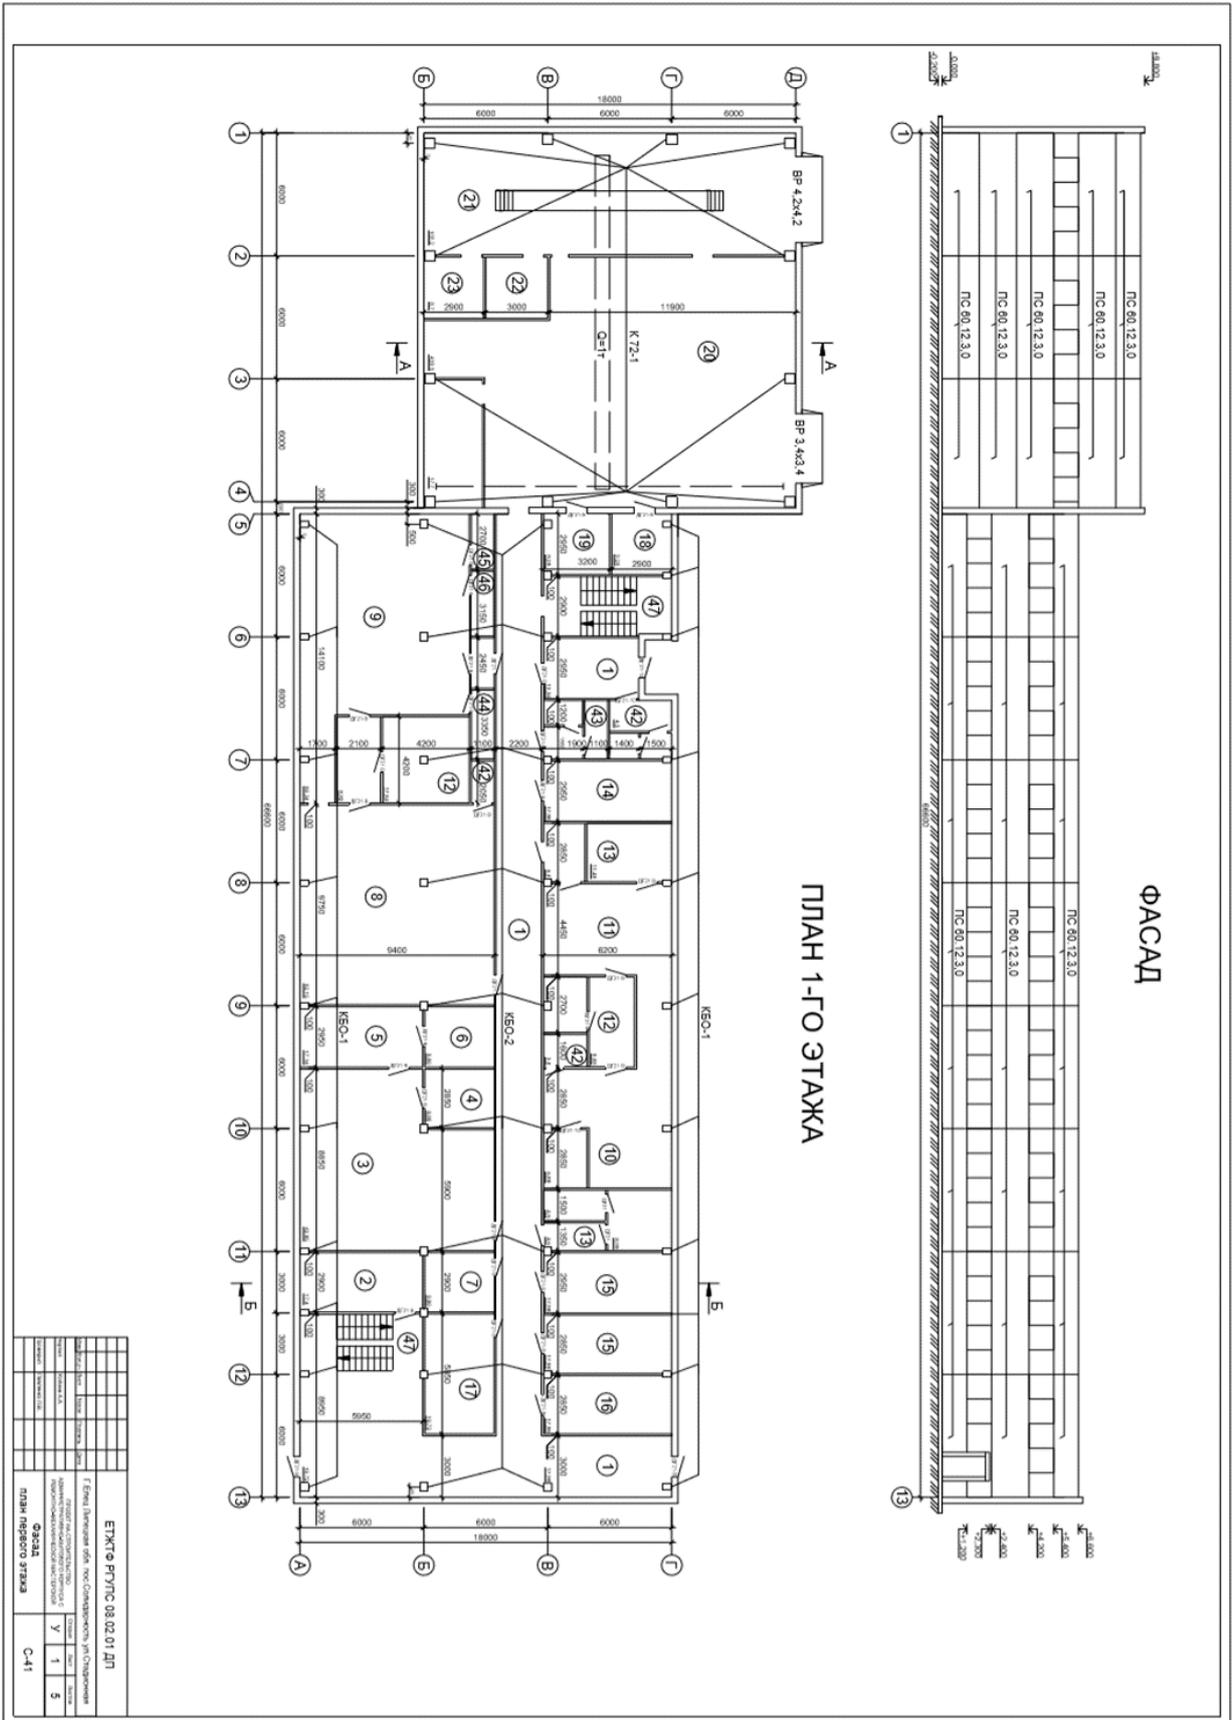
Проект на строительство административно-бытового корпуса с ремонтно - механической мастерской.
